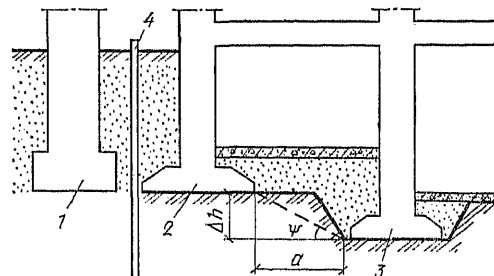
Схема защиты существующего здания от дополнительных осадков при возведении рядом нового здания с большей глубиной заложения фундамента
